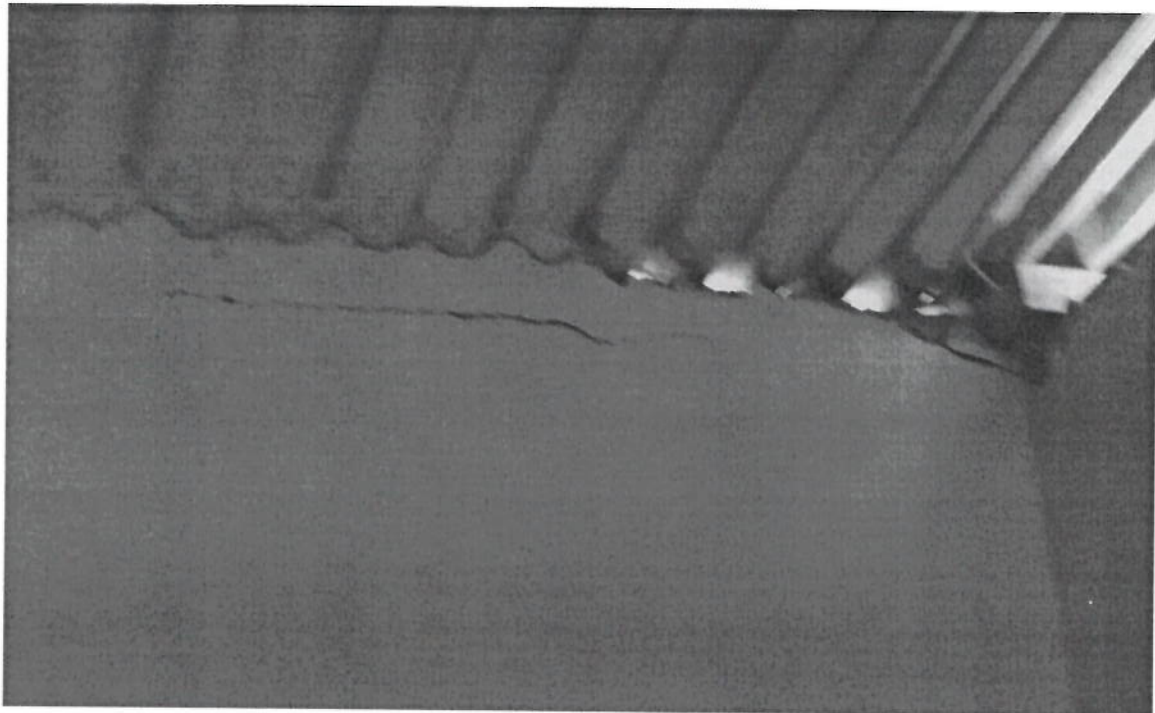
Se observa rajaduras en los encuentros del muro y el techo de calamina
